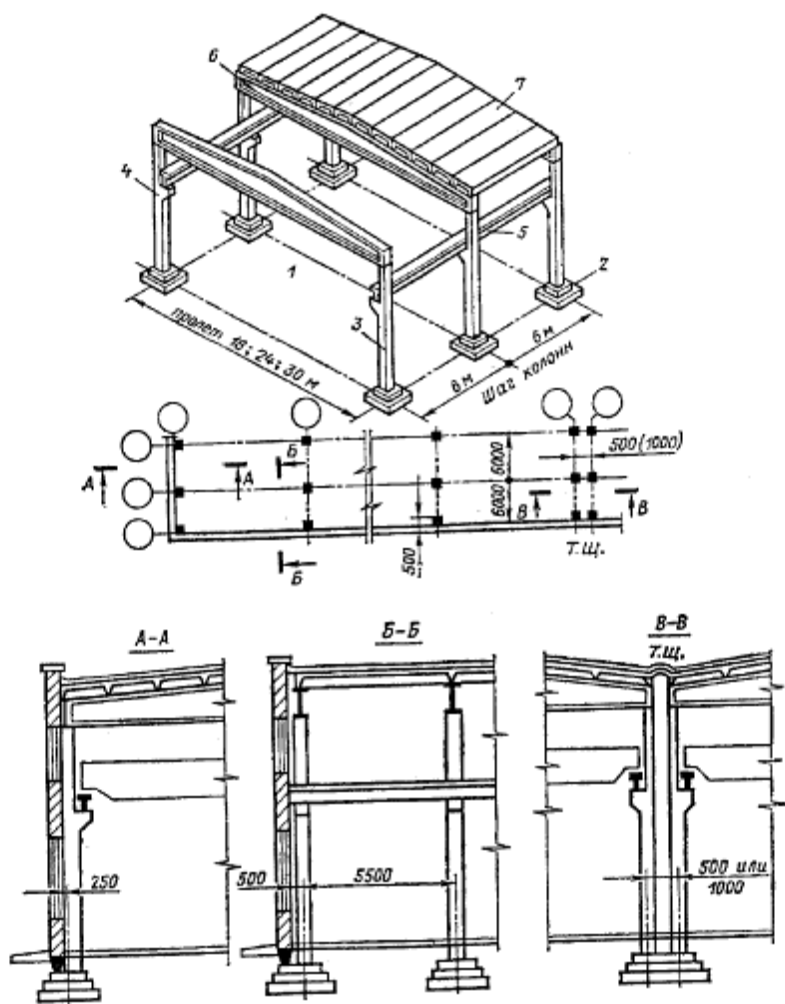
Конструктивная схема производственного здания, оборудованного кранами: 1 – разбивочные оси; 2 – сборные железобетонные фундаменты; 3 – сборные железобетонные колонны; 4 – консоли колонн; 5 – подкрановые балки; 6 – стропильные балки; 7 – плиты покрытий.
